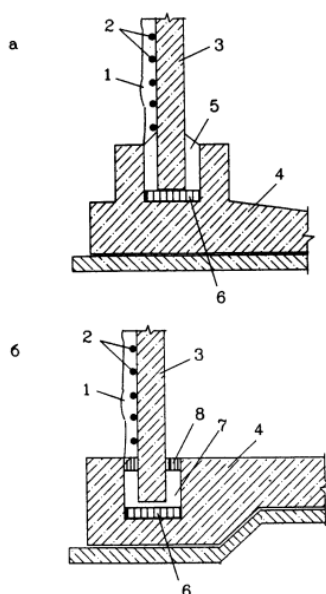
Узел сопряжения стеновых панелей с дном: а – жесткое сопряжение; б – подвижное. 1 – слой торкрет-бетона, 2 – кольцевая напрягаемая арматура, 3 – стеновая панель, 4 – дном, 5 – бетон со щебнем мелких фракций, 6 – выравнивающий слой раствора, 7 – битумная мастика, 8 – асбестоцементный раствор
